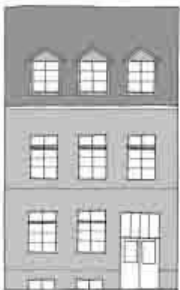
Kviste skal placeres på linje med andre vinduestyper i facaden.
